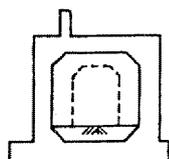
土圧作用面が一様でない場合の土圧の考え方
